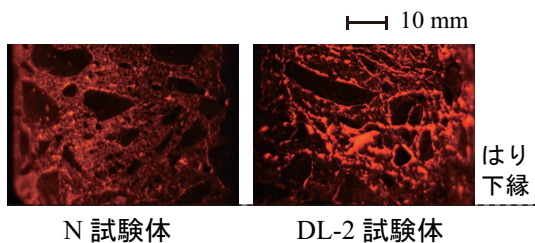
下縁かぶりコンクリート内部のひび割れ
